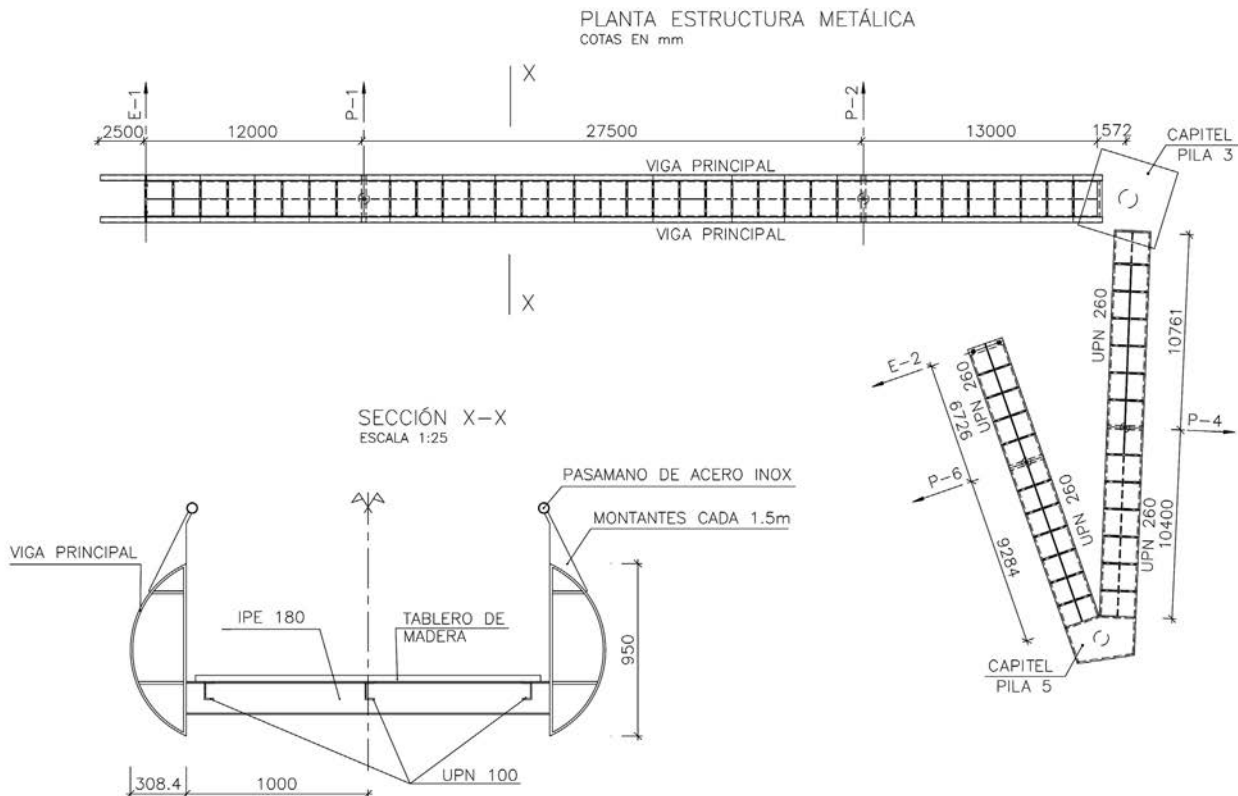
Pasarela del Gat Cendrèr. Planta de la estructura y secci3n transversal de la pasarela.
